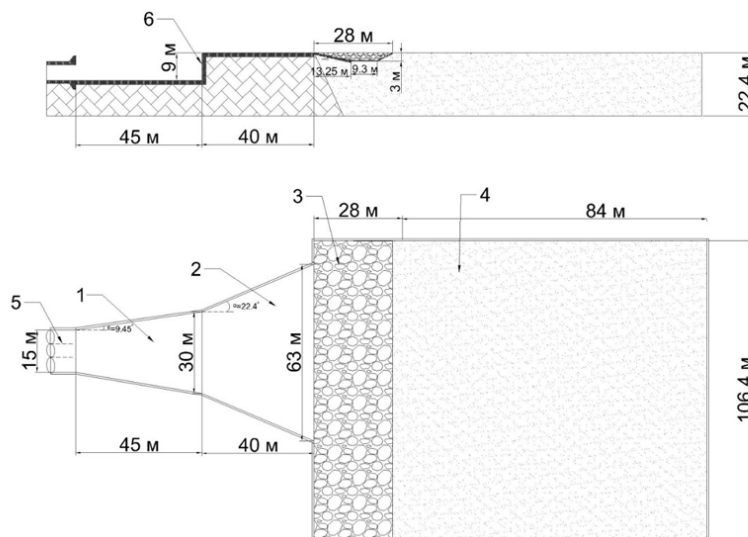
Фрагмент продольного разреза и план исследуемого участка нижнего бьефа с натурными размерами:
